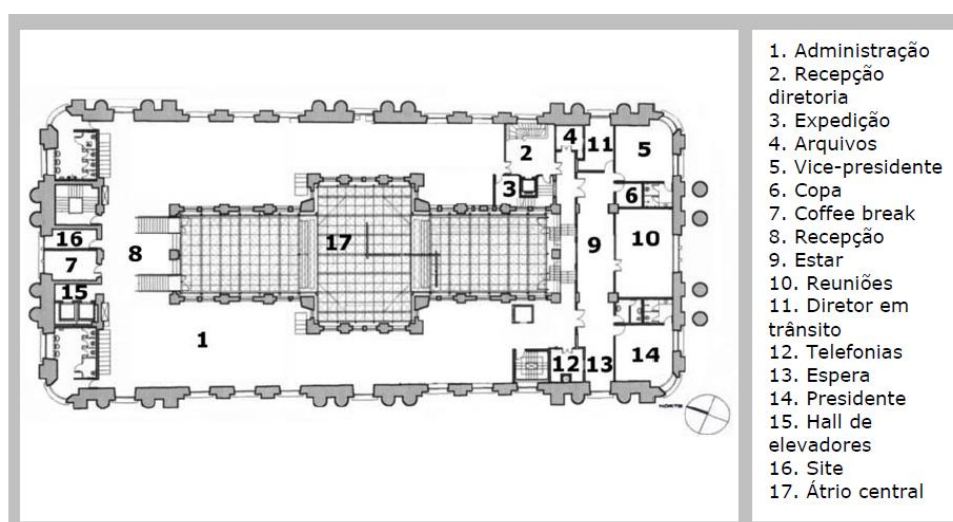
Planta baixa Santander Cultural, 1º pavimento/ Átrio Central. Fonte: TAVARES, 2007.
